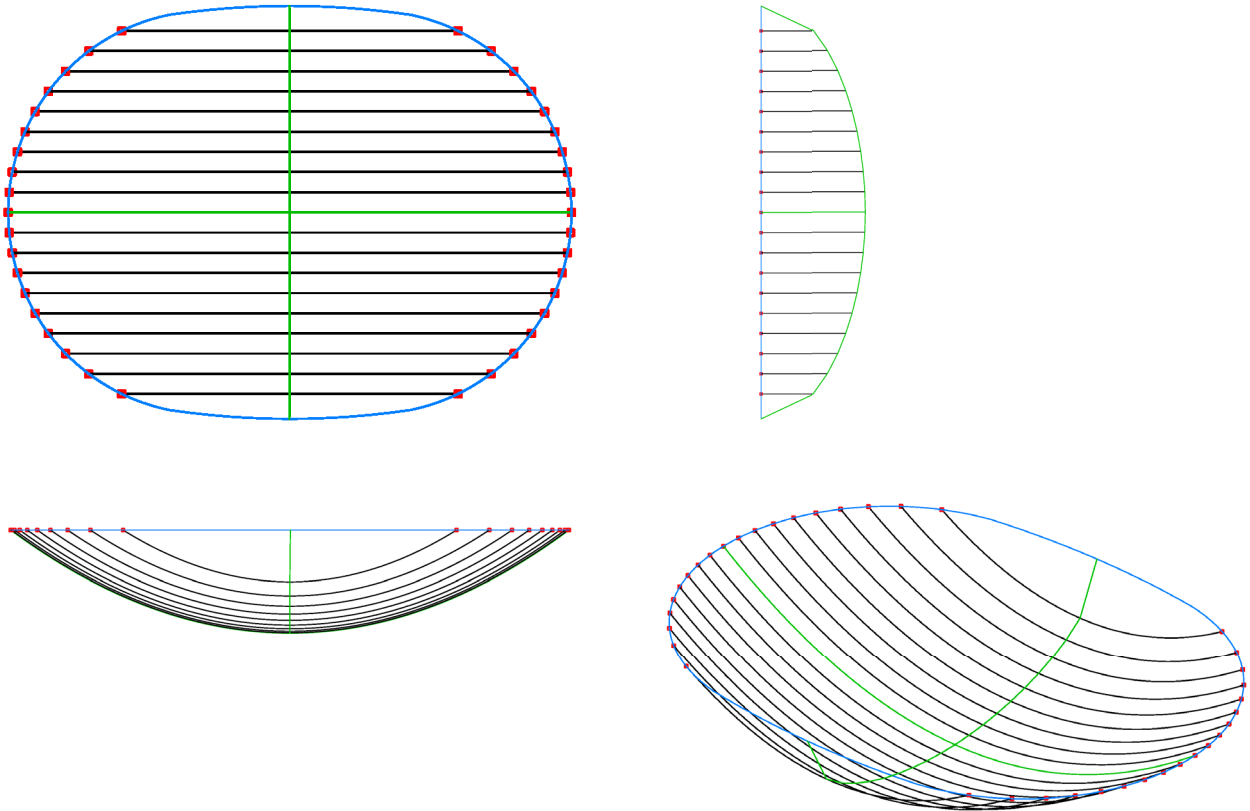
Ausgangsform B: Draufsicht mit Quer- und Längsansicht und Isometrie
